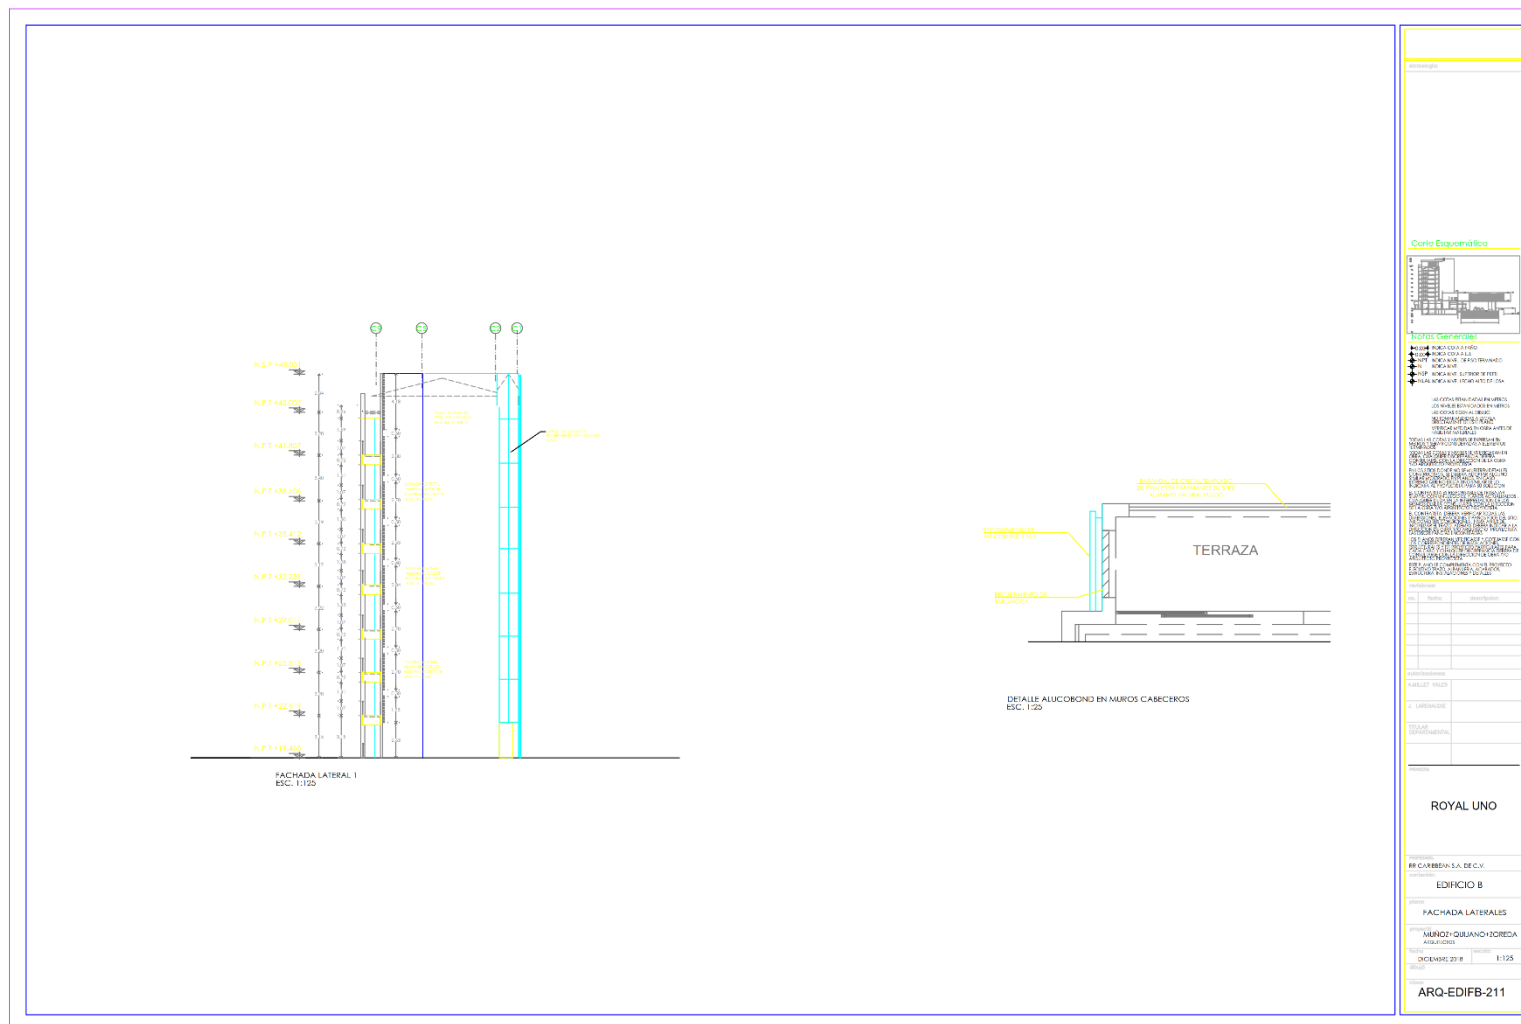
Edificio B, Fachada lateral. Anexo C-7.
